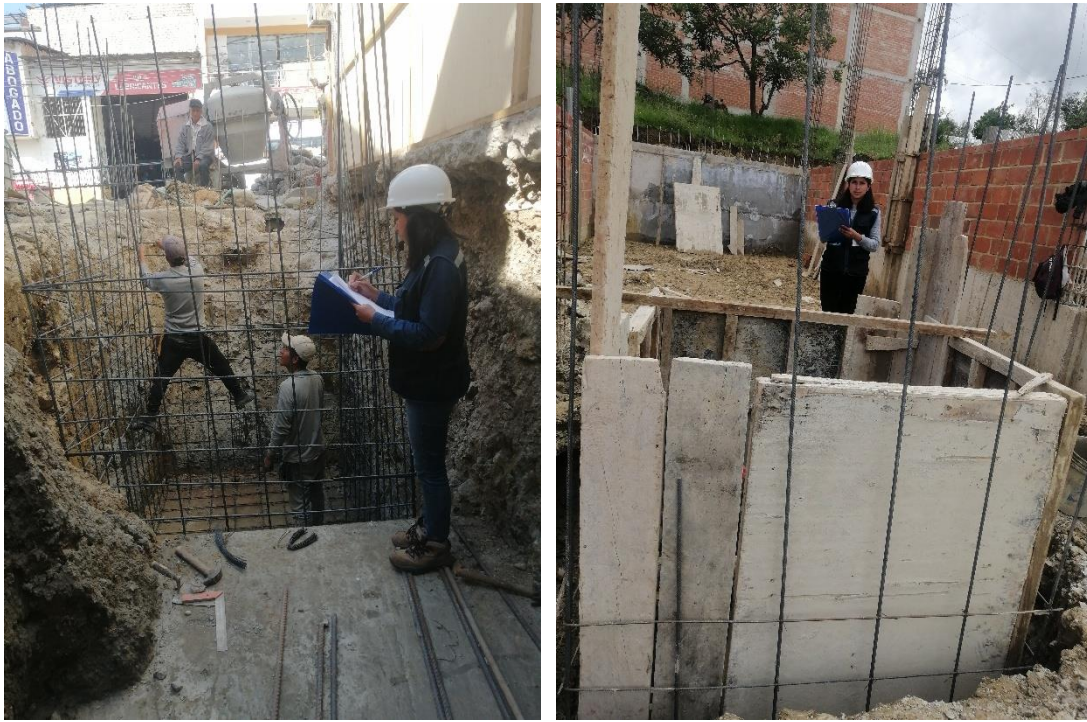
Vaciado de concreto para cisterna en vivienda N° 5.
